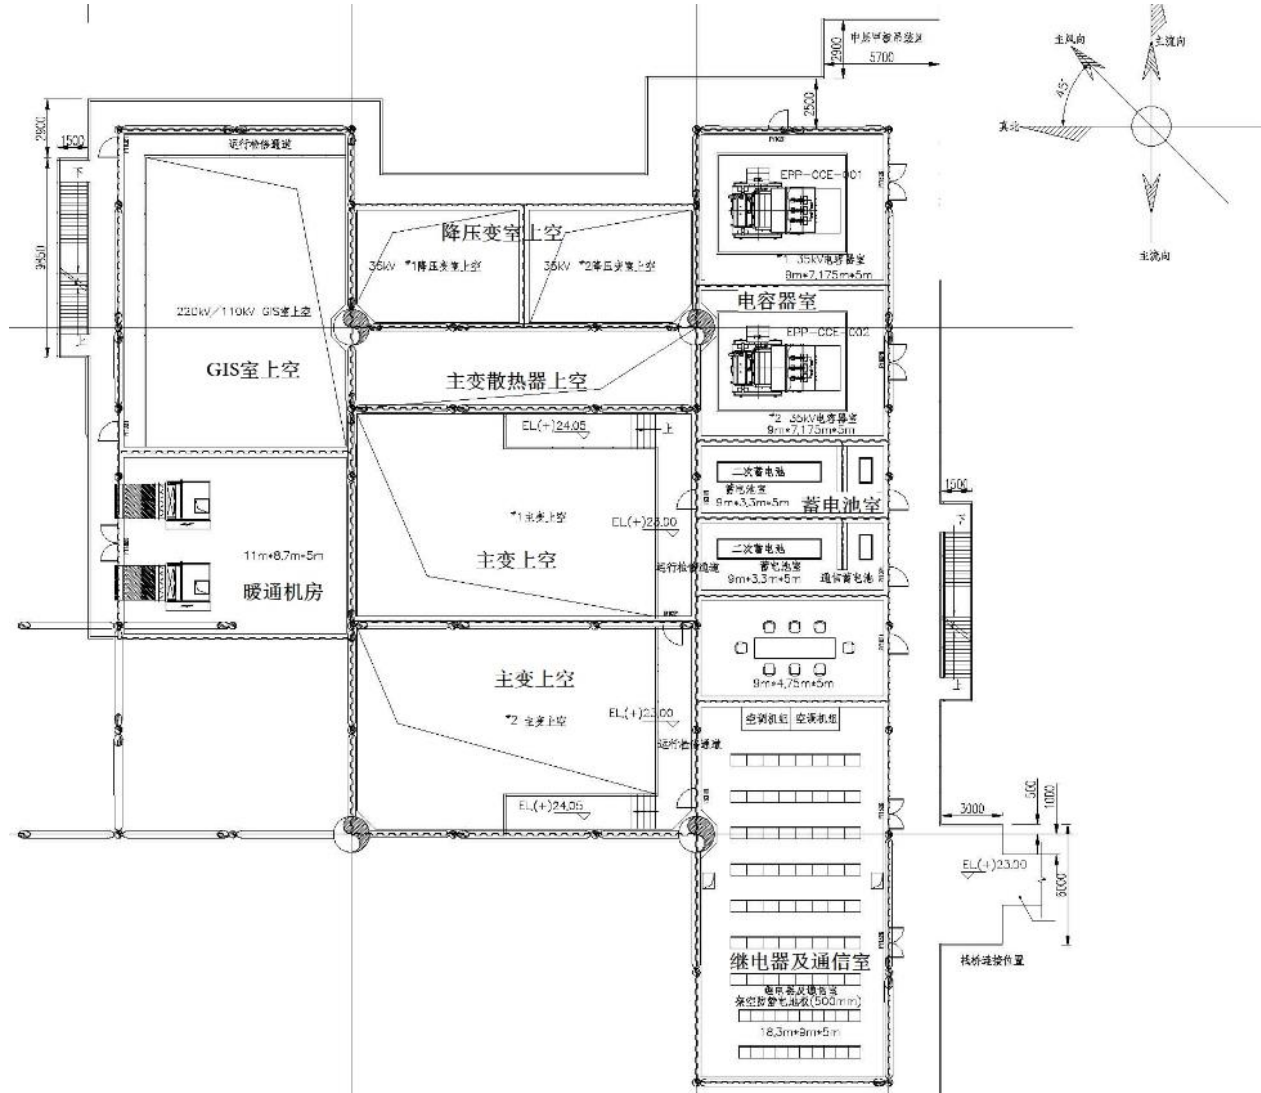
CFD11-1EPP 平台中层甲板平面布置图
